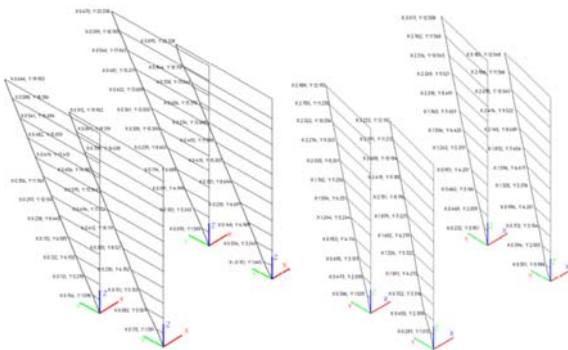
Горизонтальные перемещения угловых зон панельного здания от ветровой нагрузки по Y и X (условие повышенной ветровой нагрузки)
